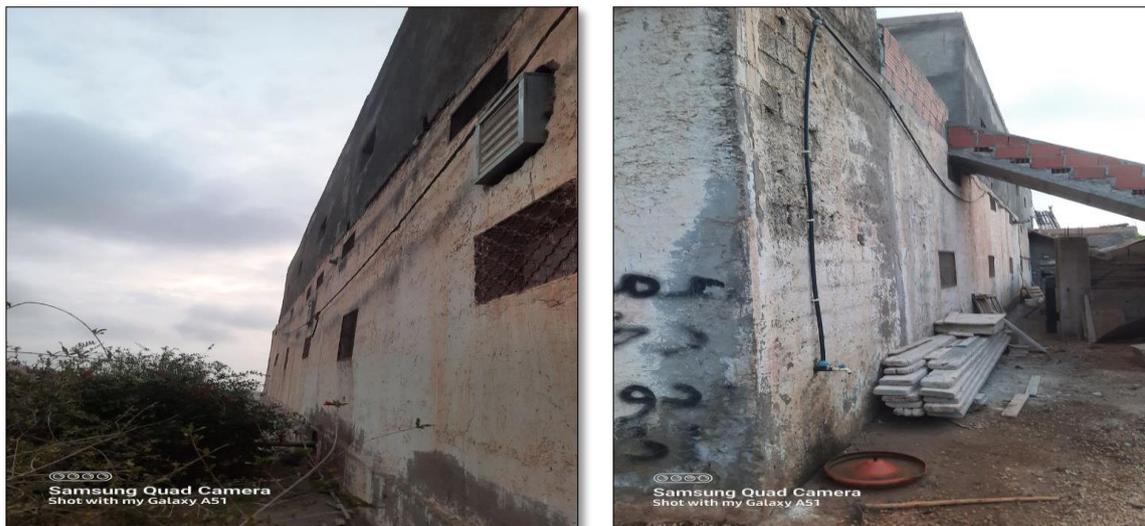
Le bâtiment d'élevage (photo personnelle. 2024)
